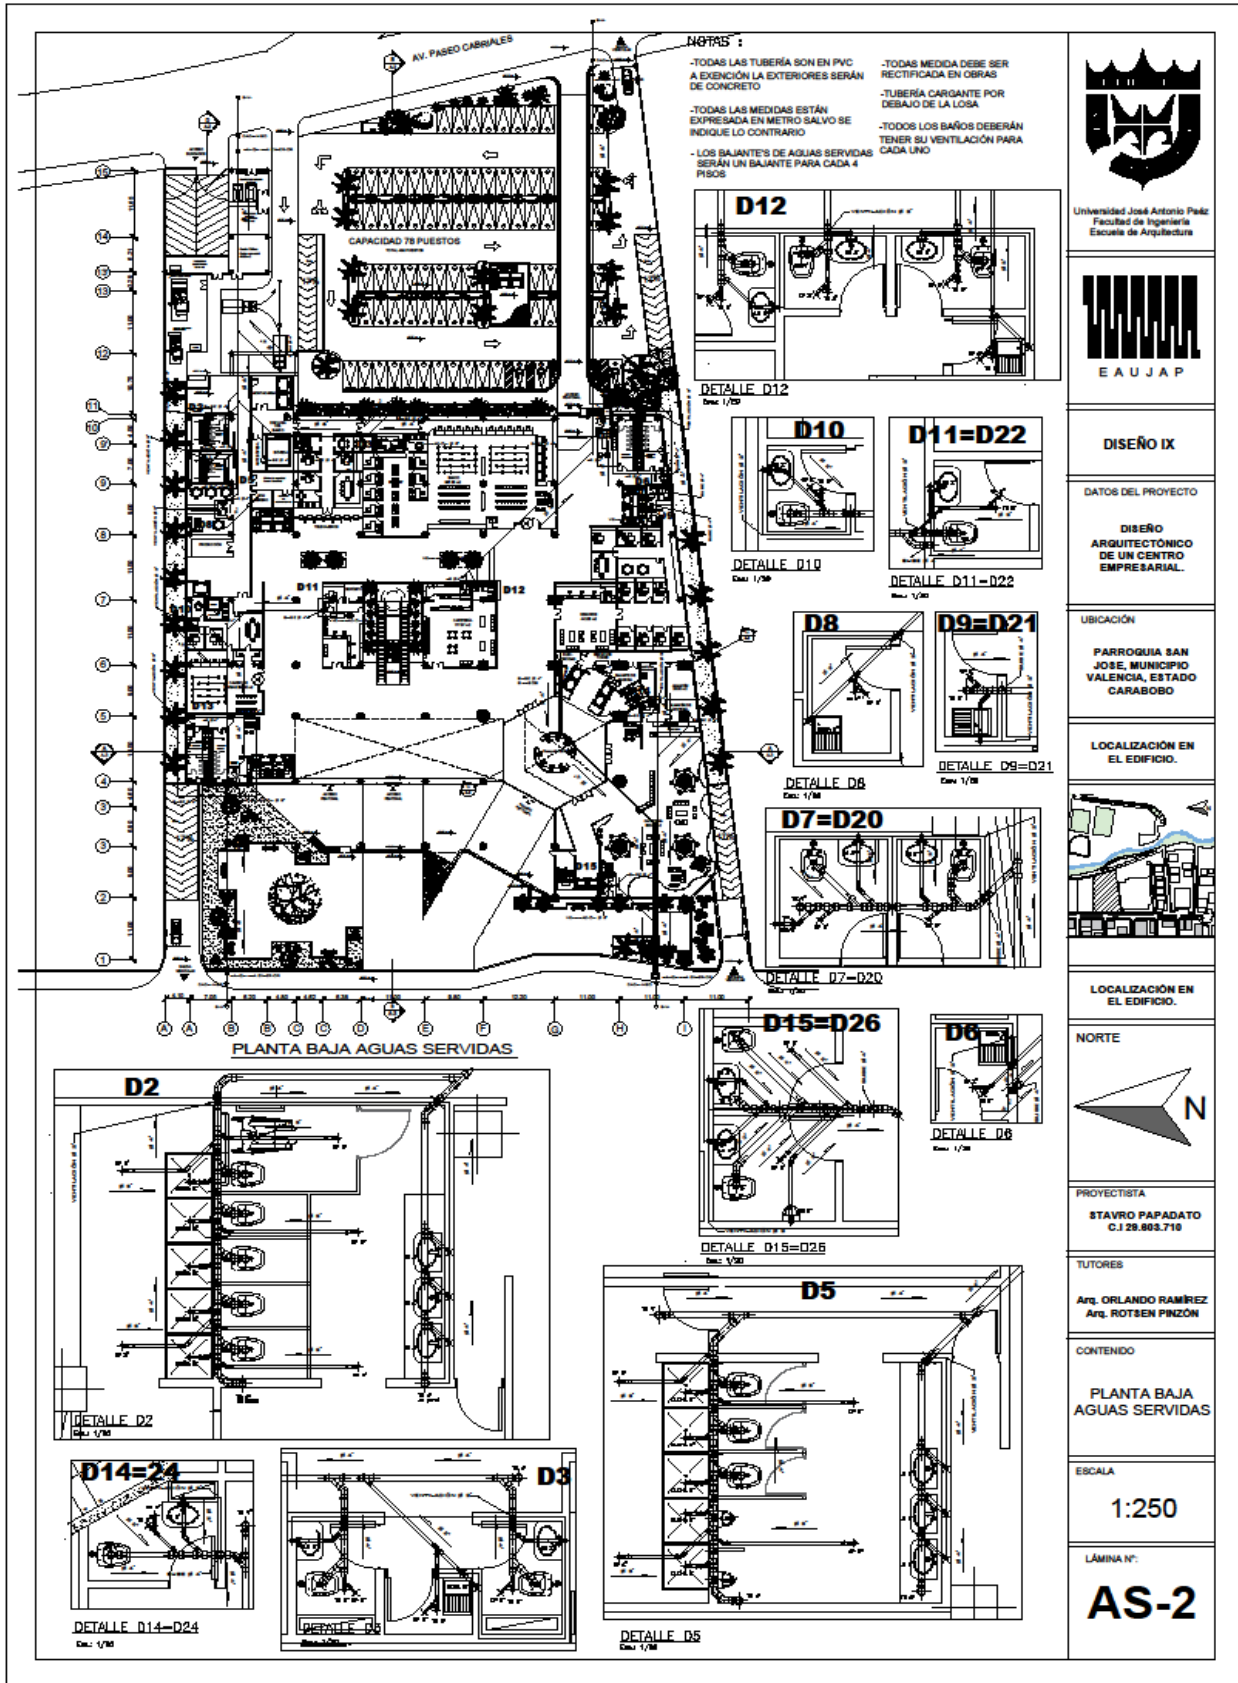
AS-2 Planta Baja Aguas Servidas. Fuente: El Autor (2023)
